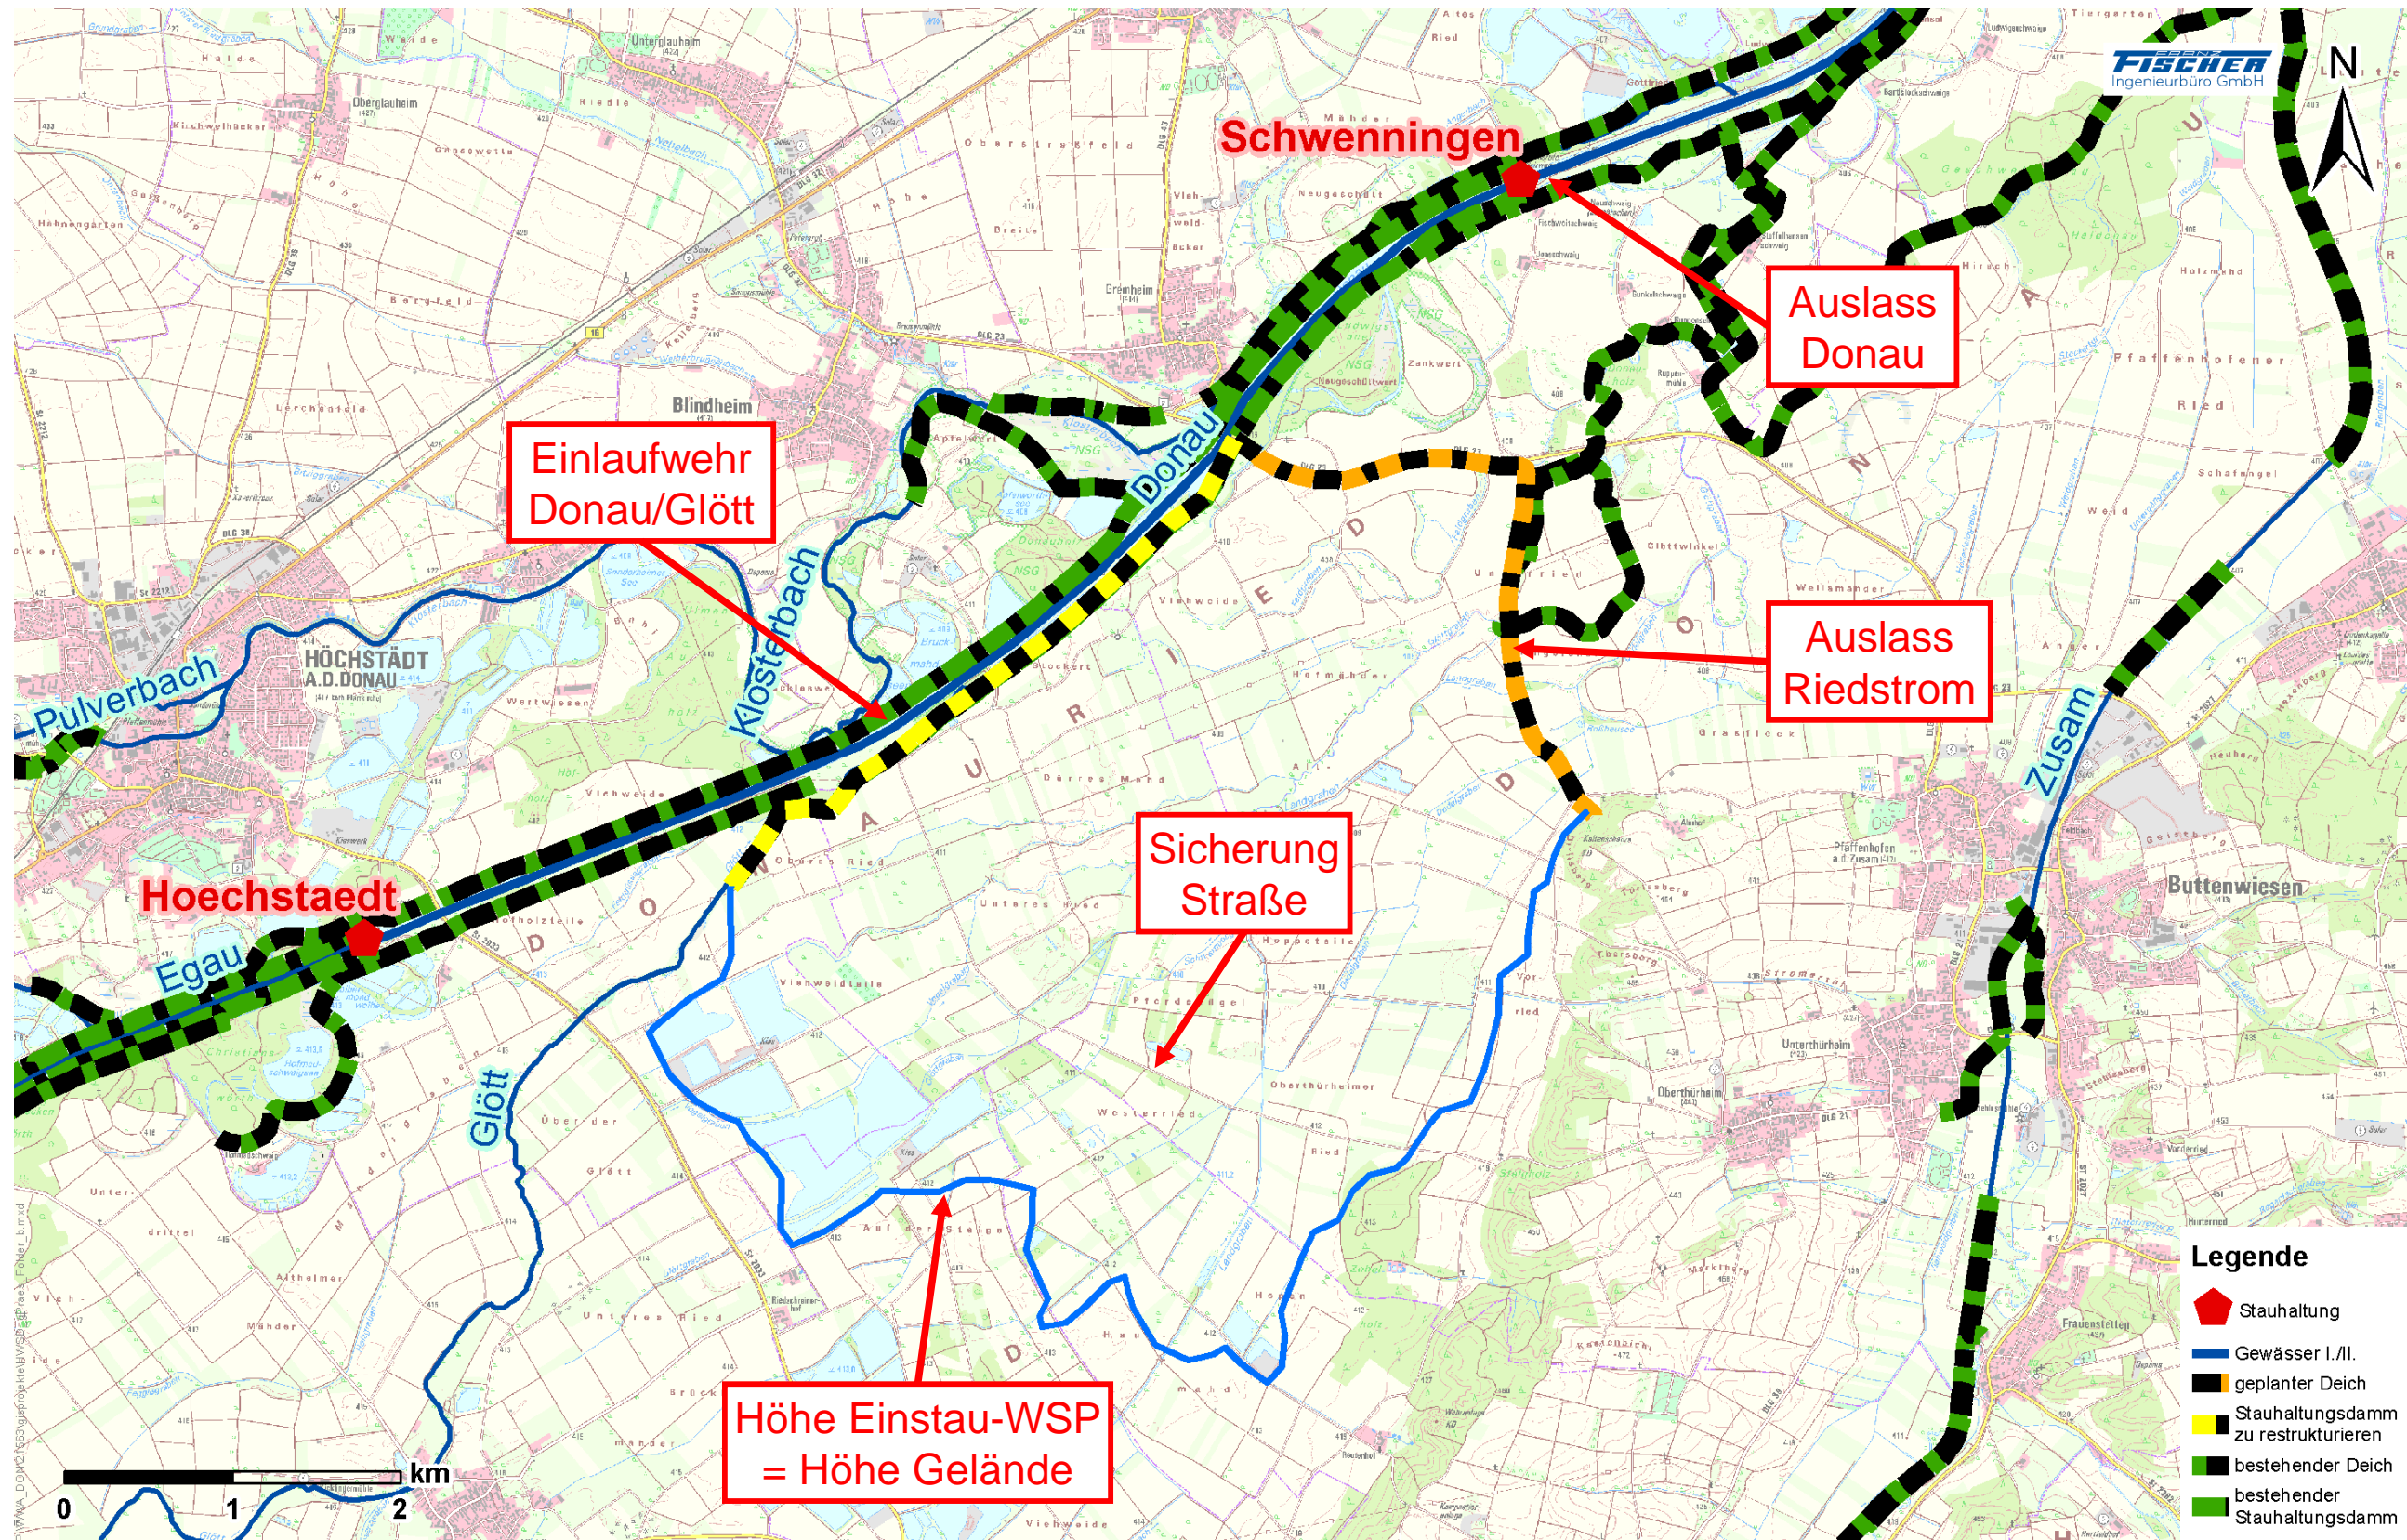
Lageplan des Polders Neugeschüttwörth b
